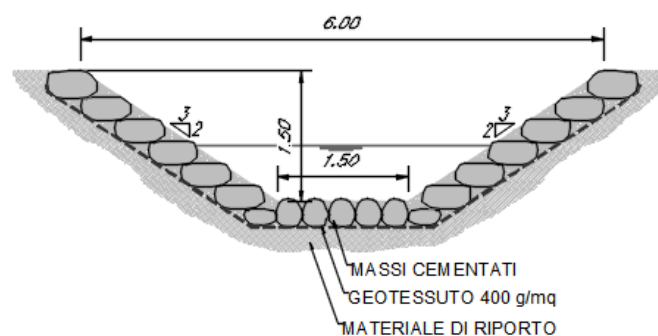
Corso d'acqua IN01_ Sezione tipo sistemazione
